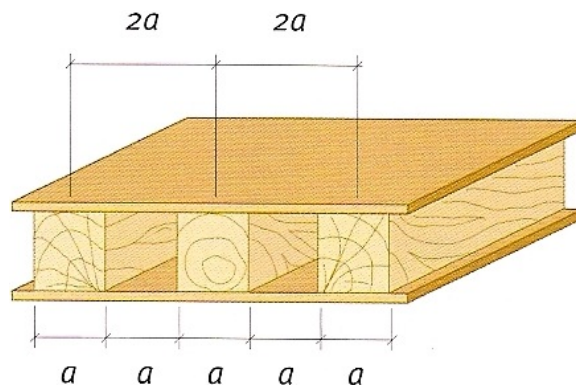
Esquema estrutural de um pavimento em madeira e respectivo afastamento das vigas [1].
